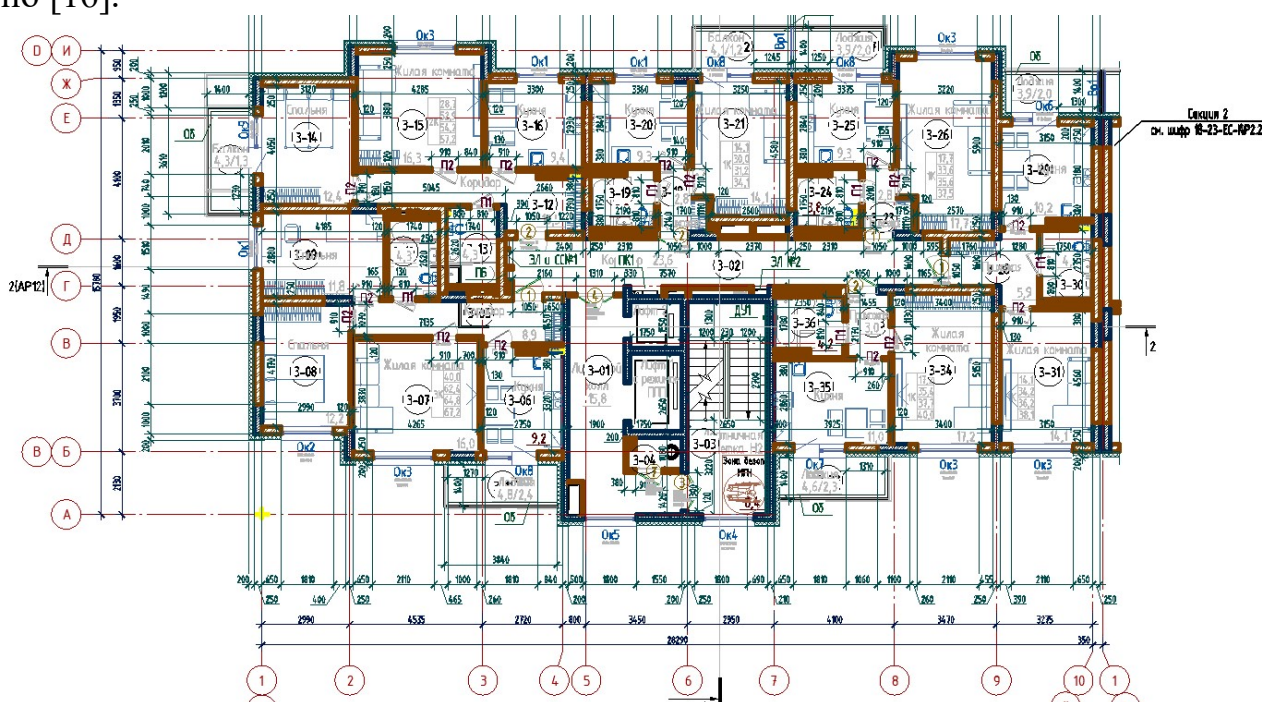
Рассматриваемая плита перекрытия типового этажа
